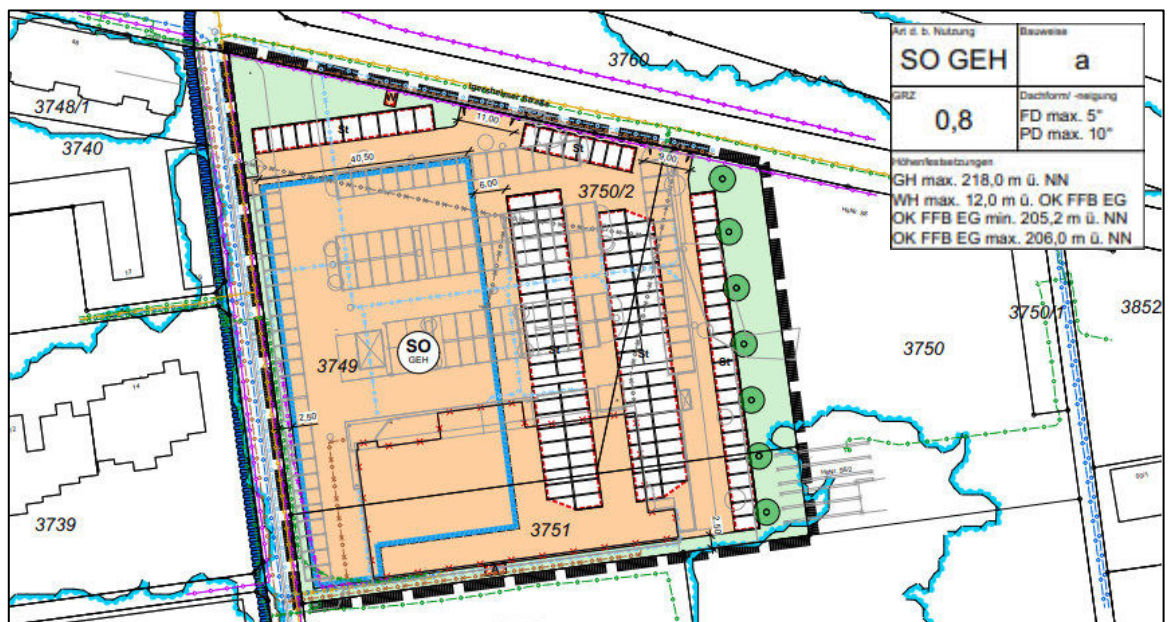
Entwurf Bebauungsplan, Zukunftsstadt Auenland - Teil 1' [22]
